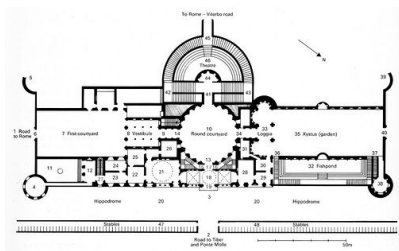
Arriba. Rafael Sanzio. Planta Villa Madama. 1516.
